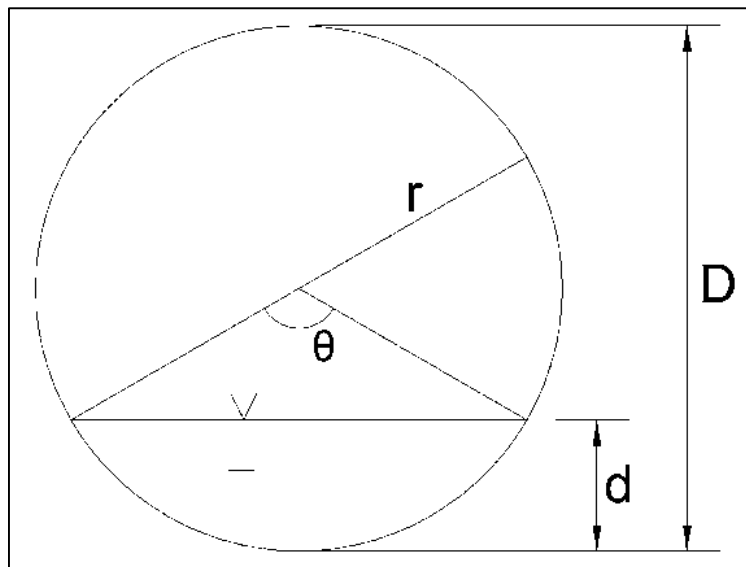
Características hidráulicas de una tubería de sección circular.
